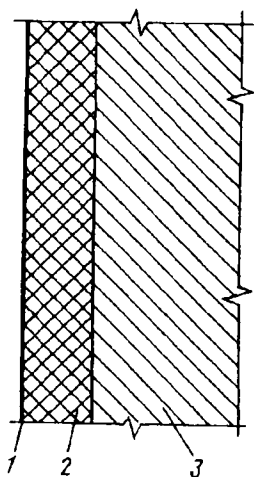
Теплоизоляционная ограждающая конструкция с дополнительным теплоизоляционным слоем с внешней стороны:
